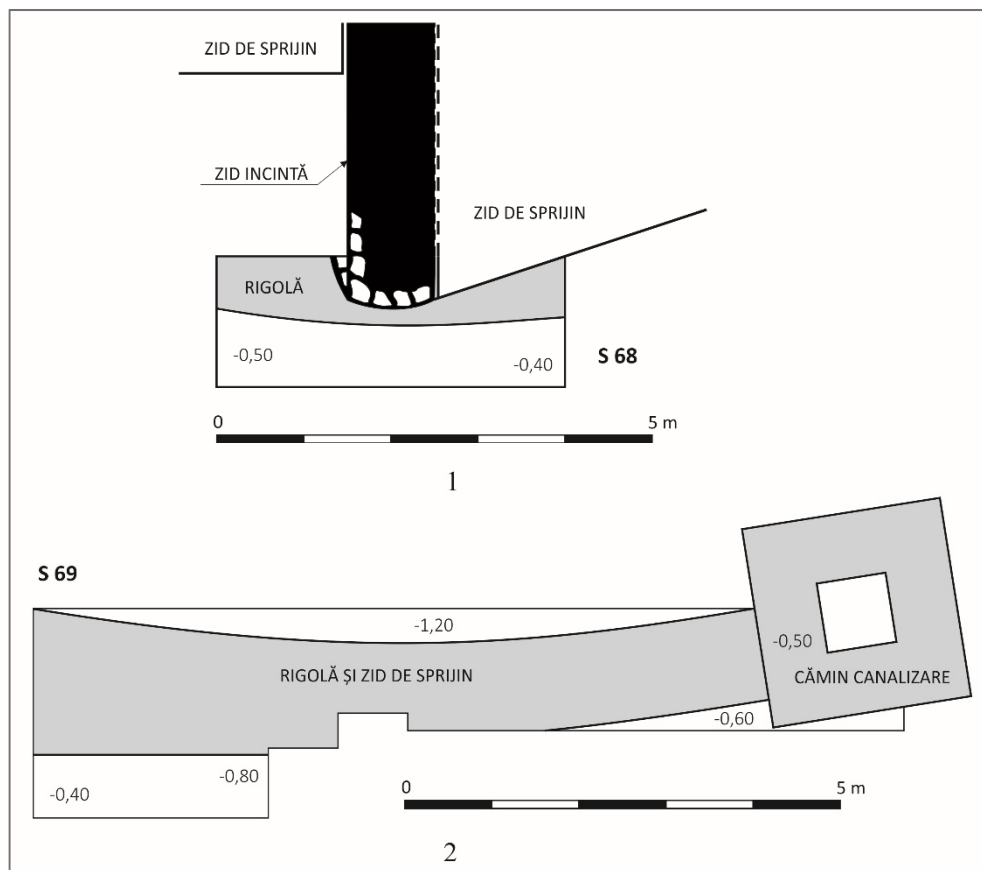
Feldioara. 1. Secțiunea 68, plan; 2. secțiunea 69, plan.
